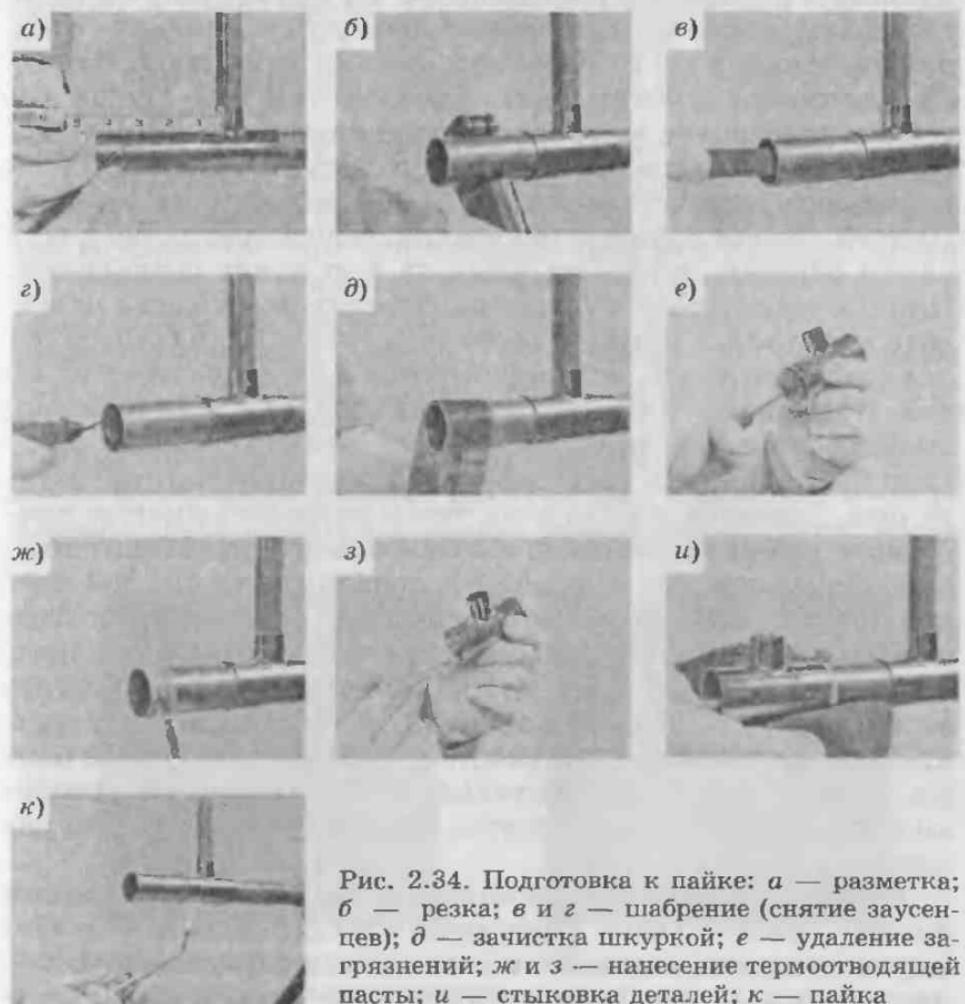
Подготовка к пайке: а — разметка; б — резка; в и г — шабрение (снятие заусенцев); д — зачистка шкуркой; е — удаление загрязнений; ж и з — нанесение термоотводящей пасты; и —стыковка деталей; к — пайка
